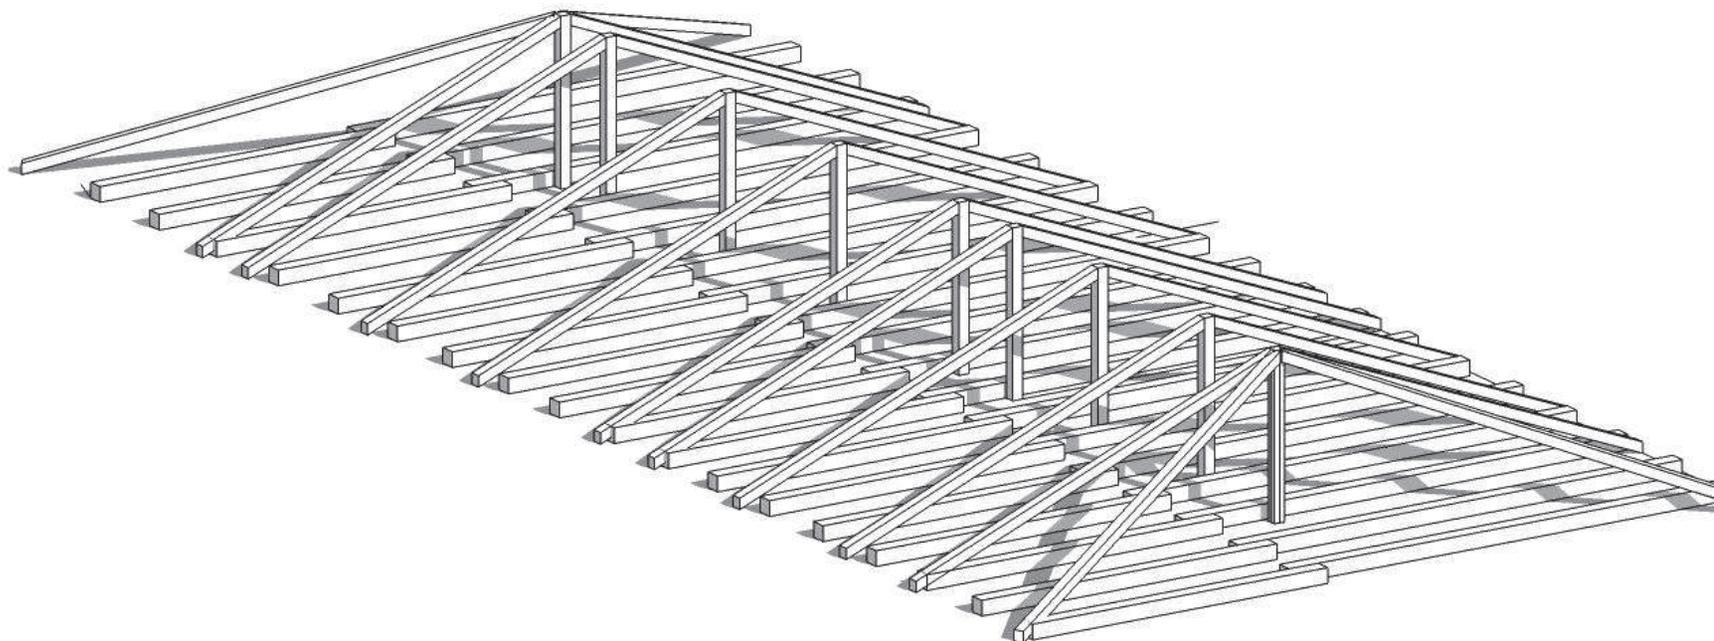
estructura de madera para cubierta de techa, Casa Parroquial.
